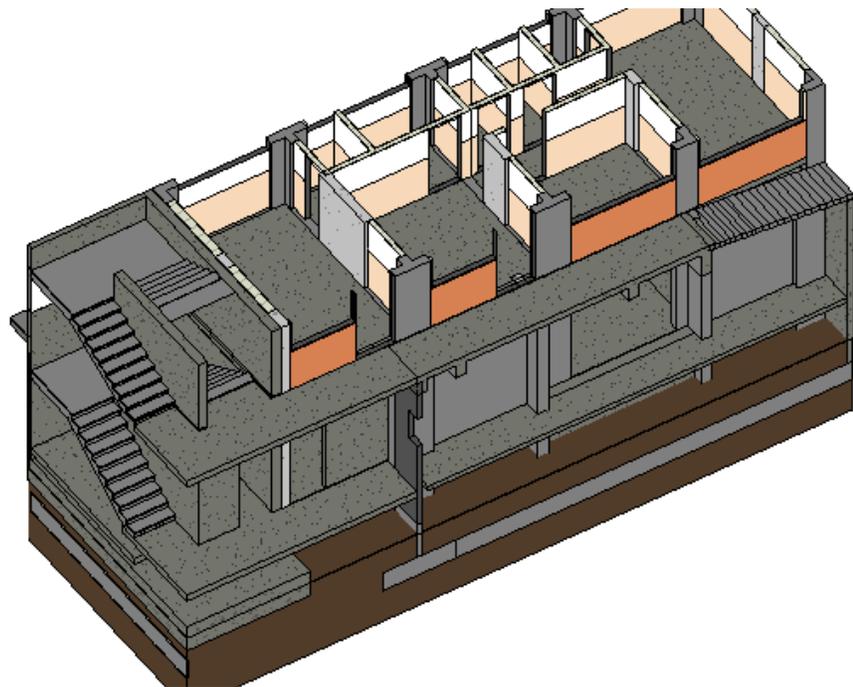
PAB C: Primer piso de los Bloques 1,2,3
